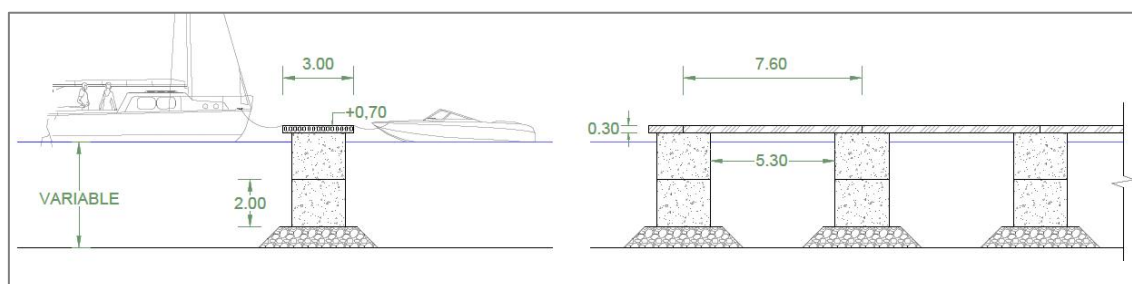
Sección transversal y alzado de pantalanés (todas las cotas en metros)
